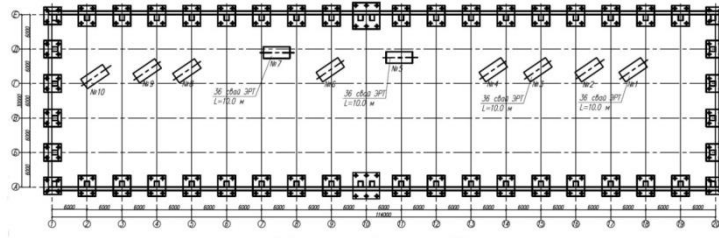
План свайного поля из буронабивных свай-ЭРТ усиления оснований фундаментов каркаса и кузнечных молотов №№1,3,5,7.
